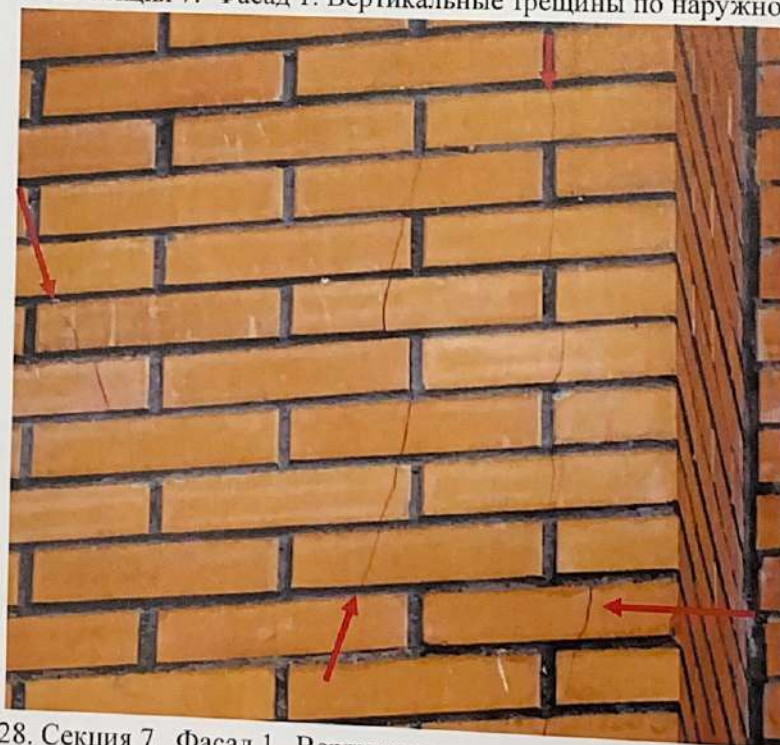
Секция 7. Фасад 1. Вертикальные трещины по наружное версте.
